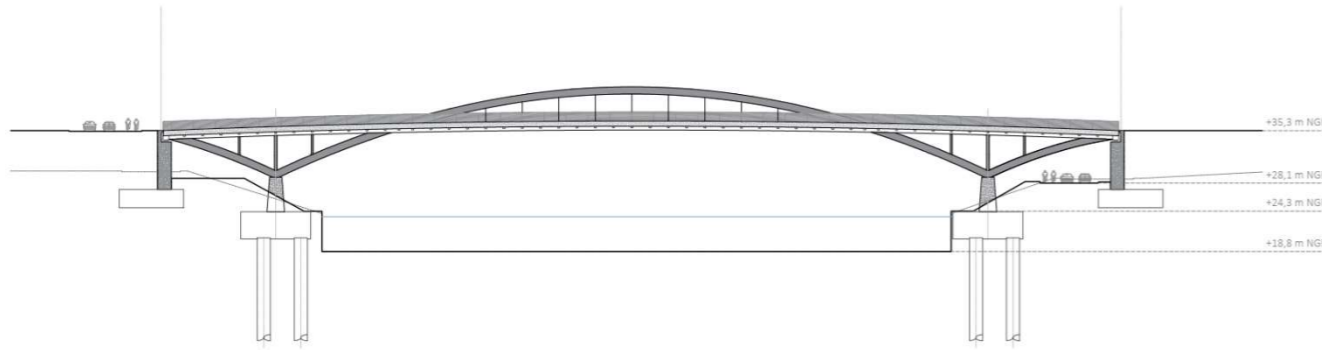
Vista longitudinal de puente (fuente: elaboración propia)
